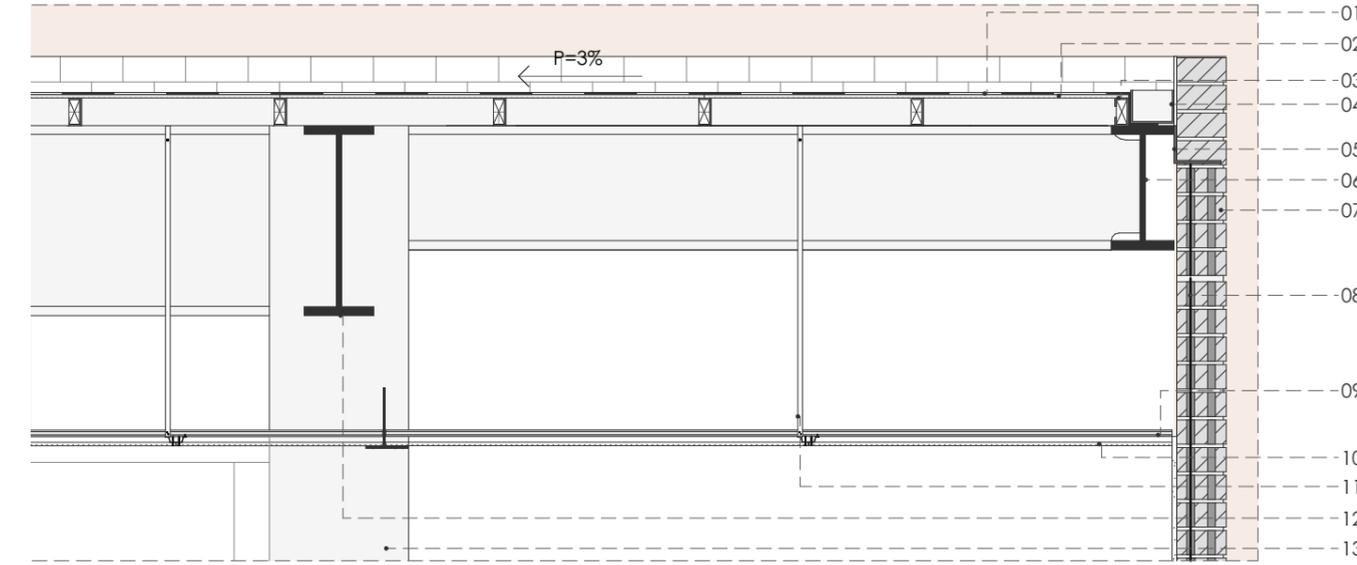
Detalle 02 - cubierta Fuente: Propia, 2022
